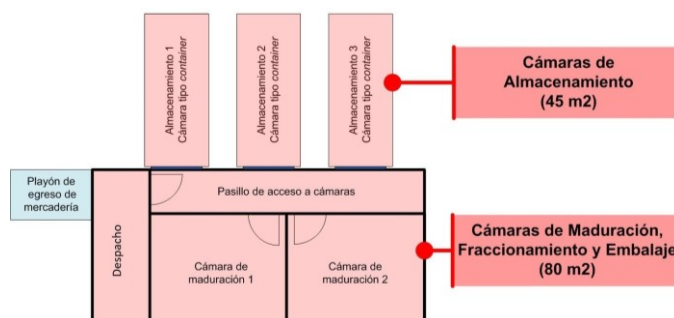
Plano Cámaras de Maduración y Almacenamiento.
